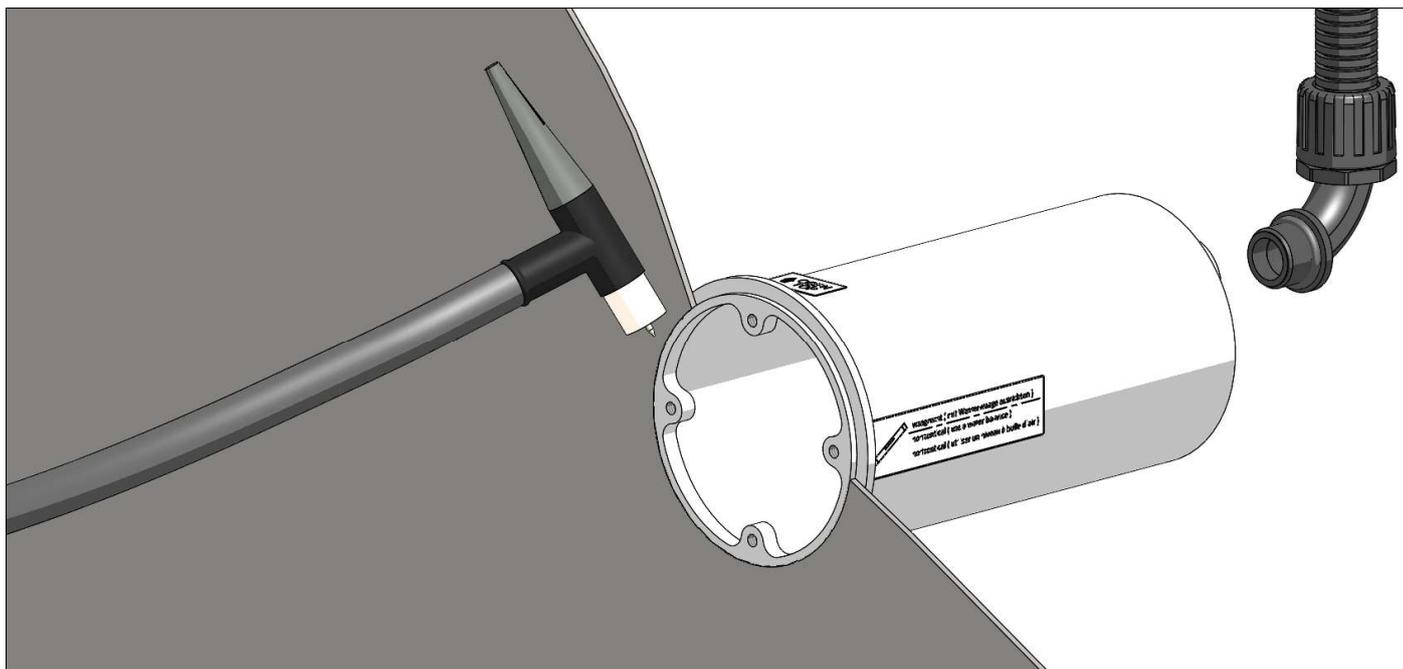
Встраиваемый корпус для бассейна из нержавеющей стали – сварка заподлицо с бассейном (затем герметично подключить систему защиты кабеля)
